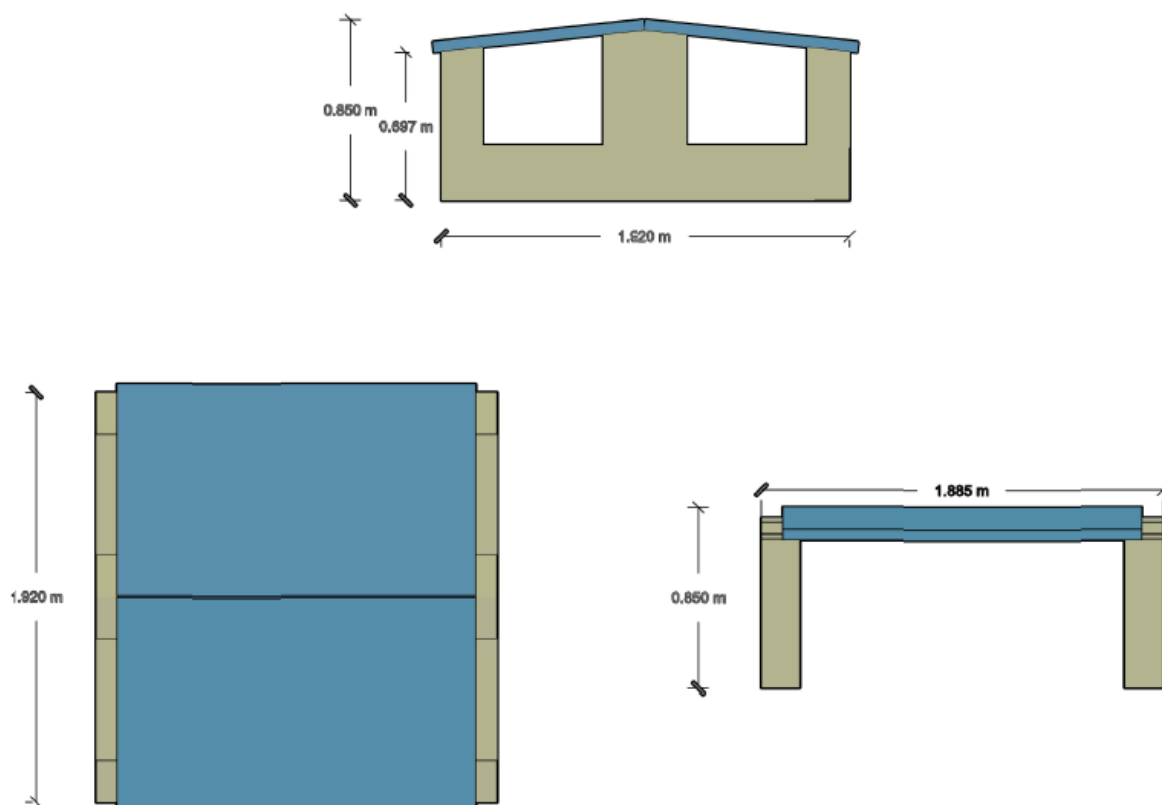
Coupe type d'une structure porteuse (PEE P6)
